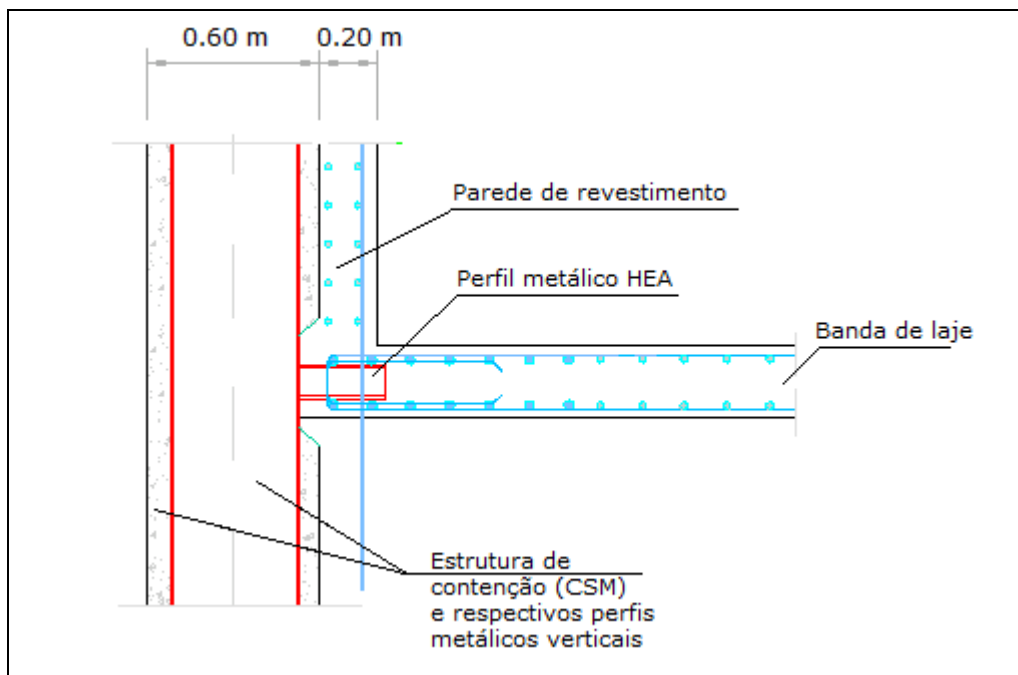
Representação em corte do pormenor de ligação das bandas de laje à estrutura de contenção
